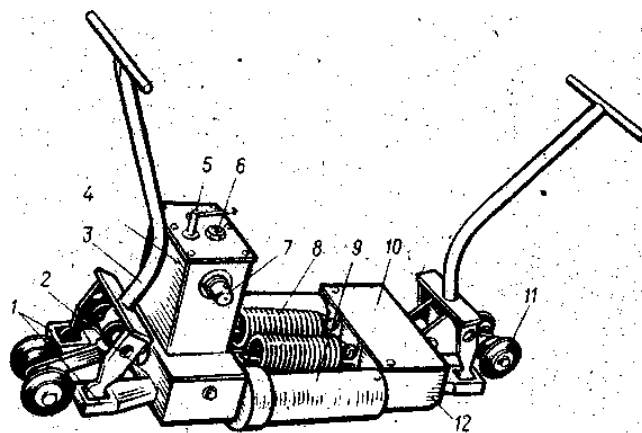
Гидравлический разгоночный прибор РН-01А:
